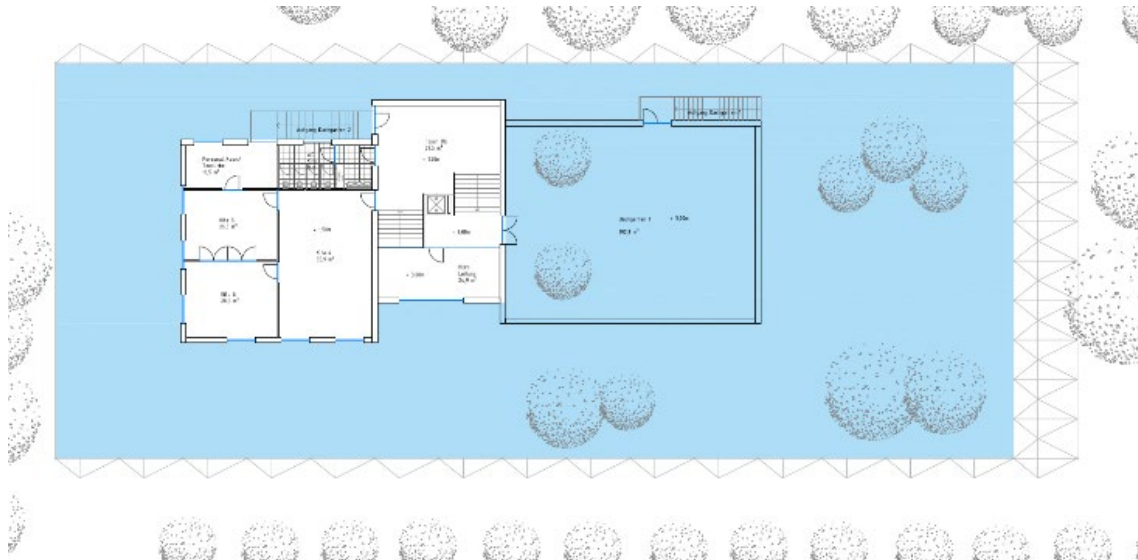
Grundriss 1. Obergeschoss Kita mit Klimahülle, Variante 4.2
